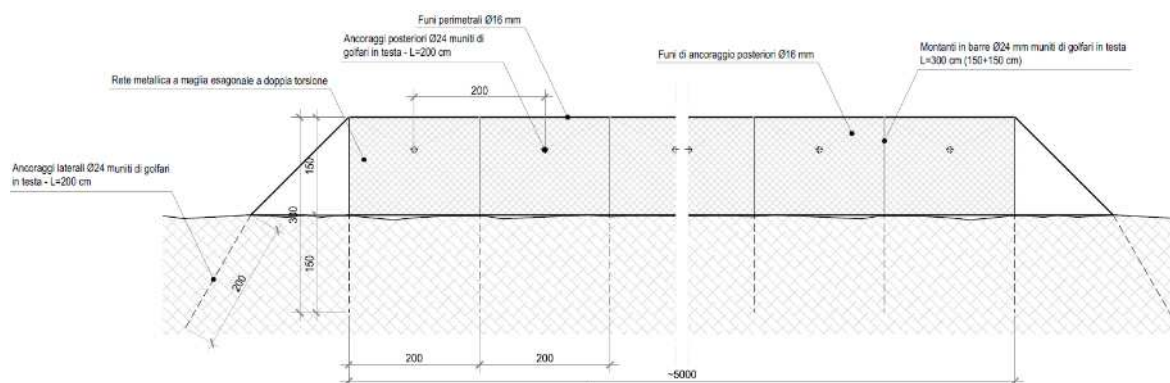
stralcio grafico del prospetto tipologico della rete di presidio (v. disegno D08)
